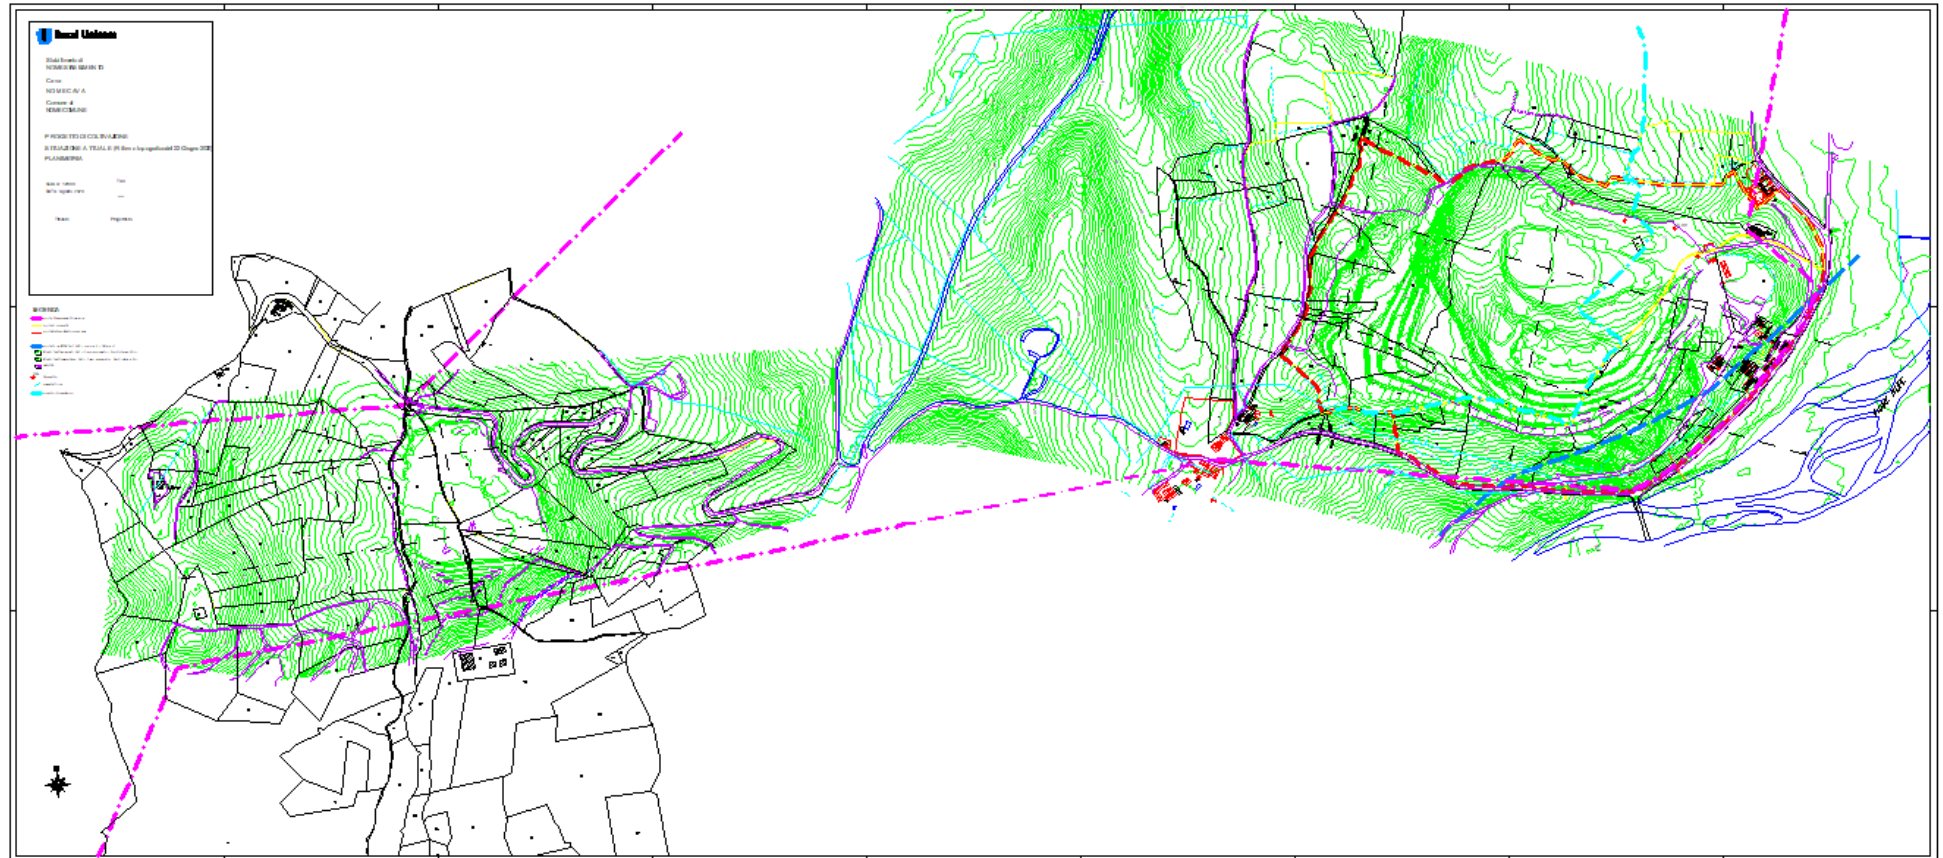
Planimetria di progetto - Fase 2 (10 anni)
